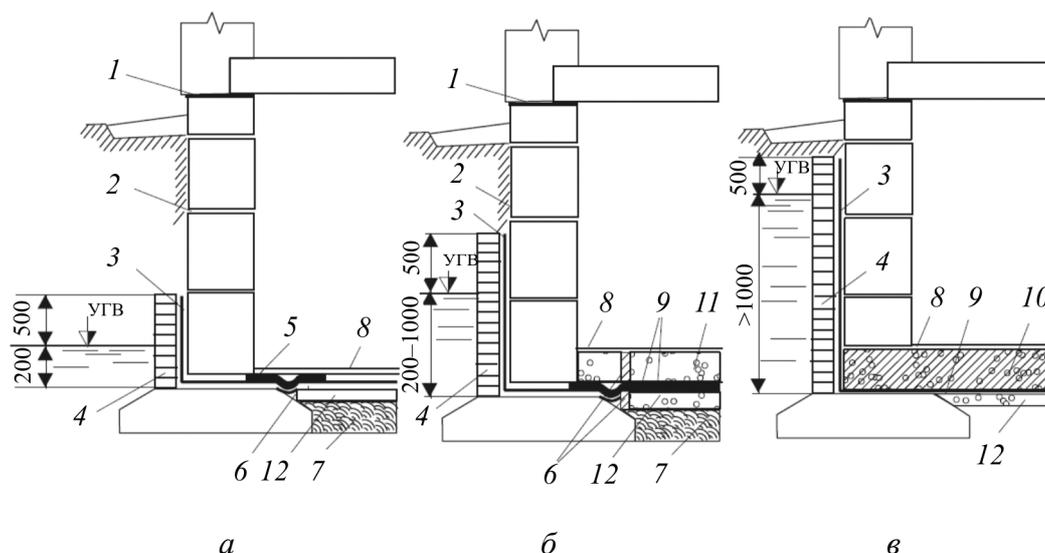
Примеры гидроизоляции фундамента: *а* – при напоре грунтовых вод менее 200 мм; *б* – при напоре 200–1000 мм; *в* – при напоре свыше 1000 мм; 1 – рулонная гидроизоляция; 2 – окрасочная гидроизоляция (промазка горячим битумом за два раза); 3 – оклеечная гидроизоляция; 4 – защитная стенка из глиняного кирпича-сырца; 5 – стеклоткань; 6 – деформационный шов; 7 – глина; 8 – пол подвала; 9 – стяжка; 10 – железобетонная плита; 11 – пригрузочный слой из бетона; 12 – подготовка [2]
